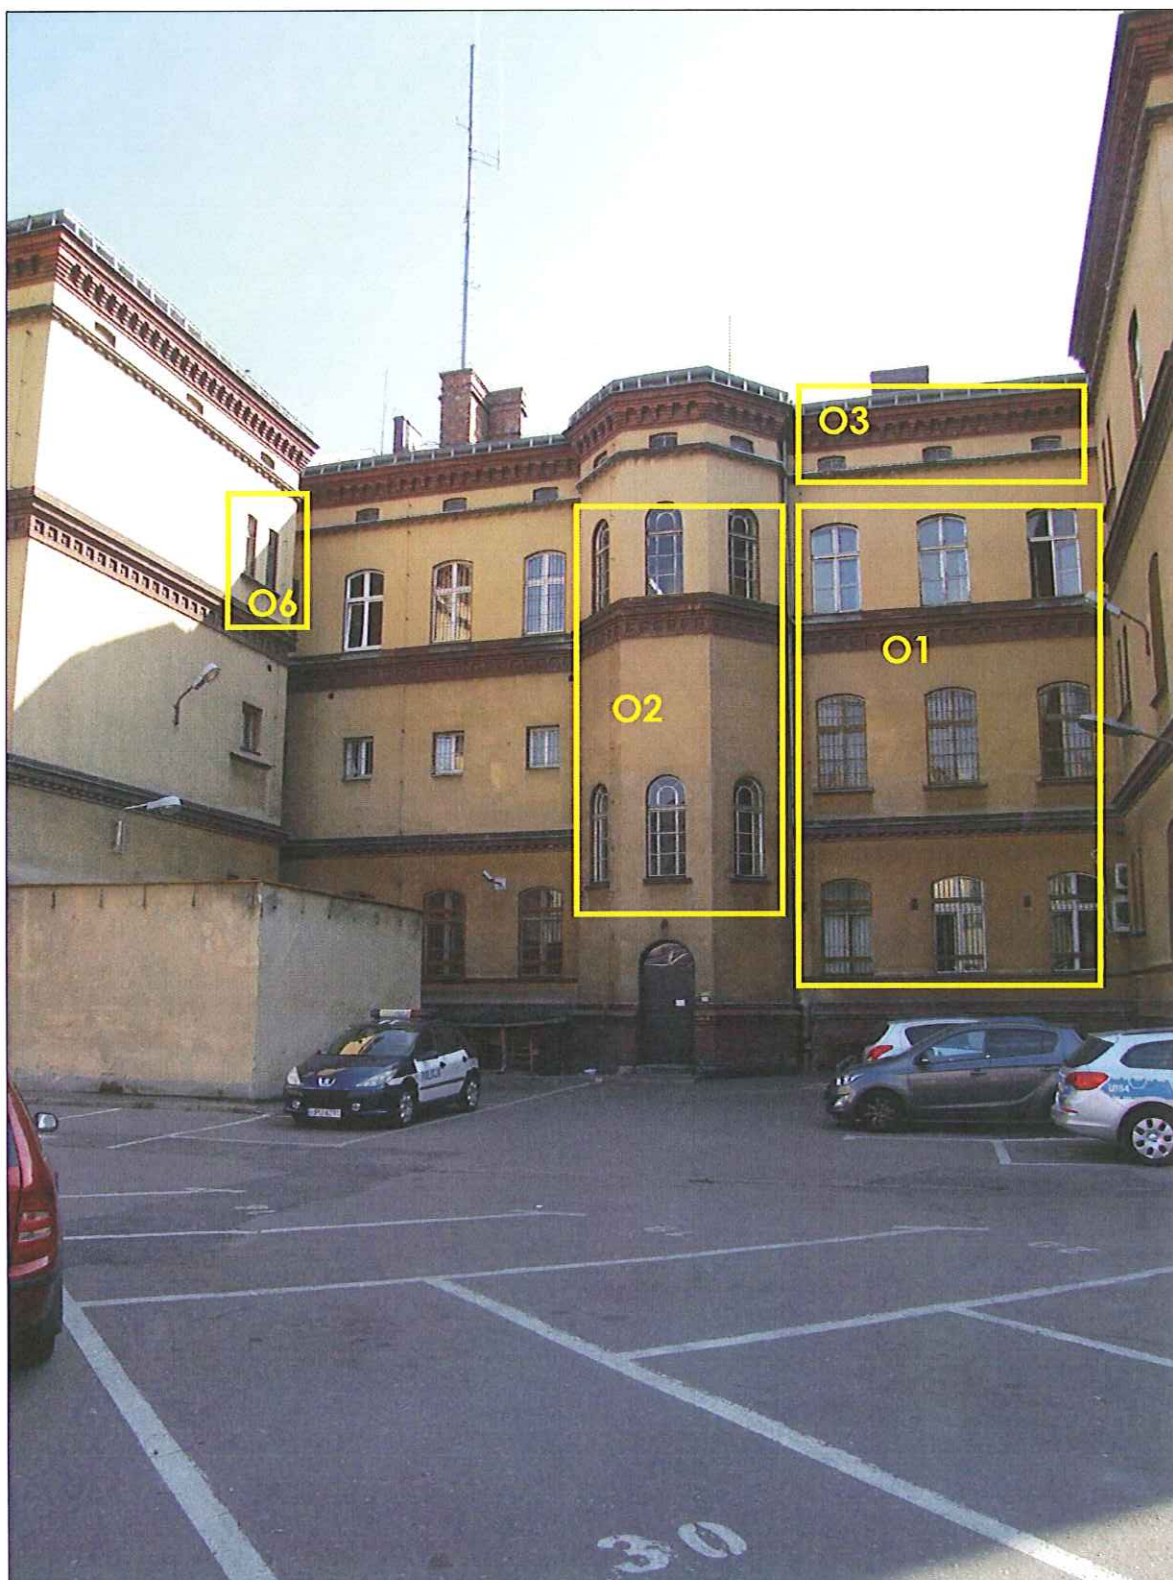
Elewacja wschodnia – przykładowa lokalizacja typów okien
